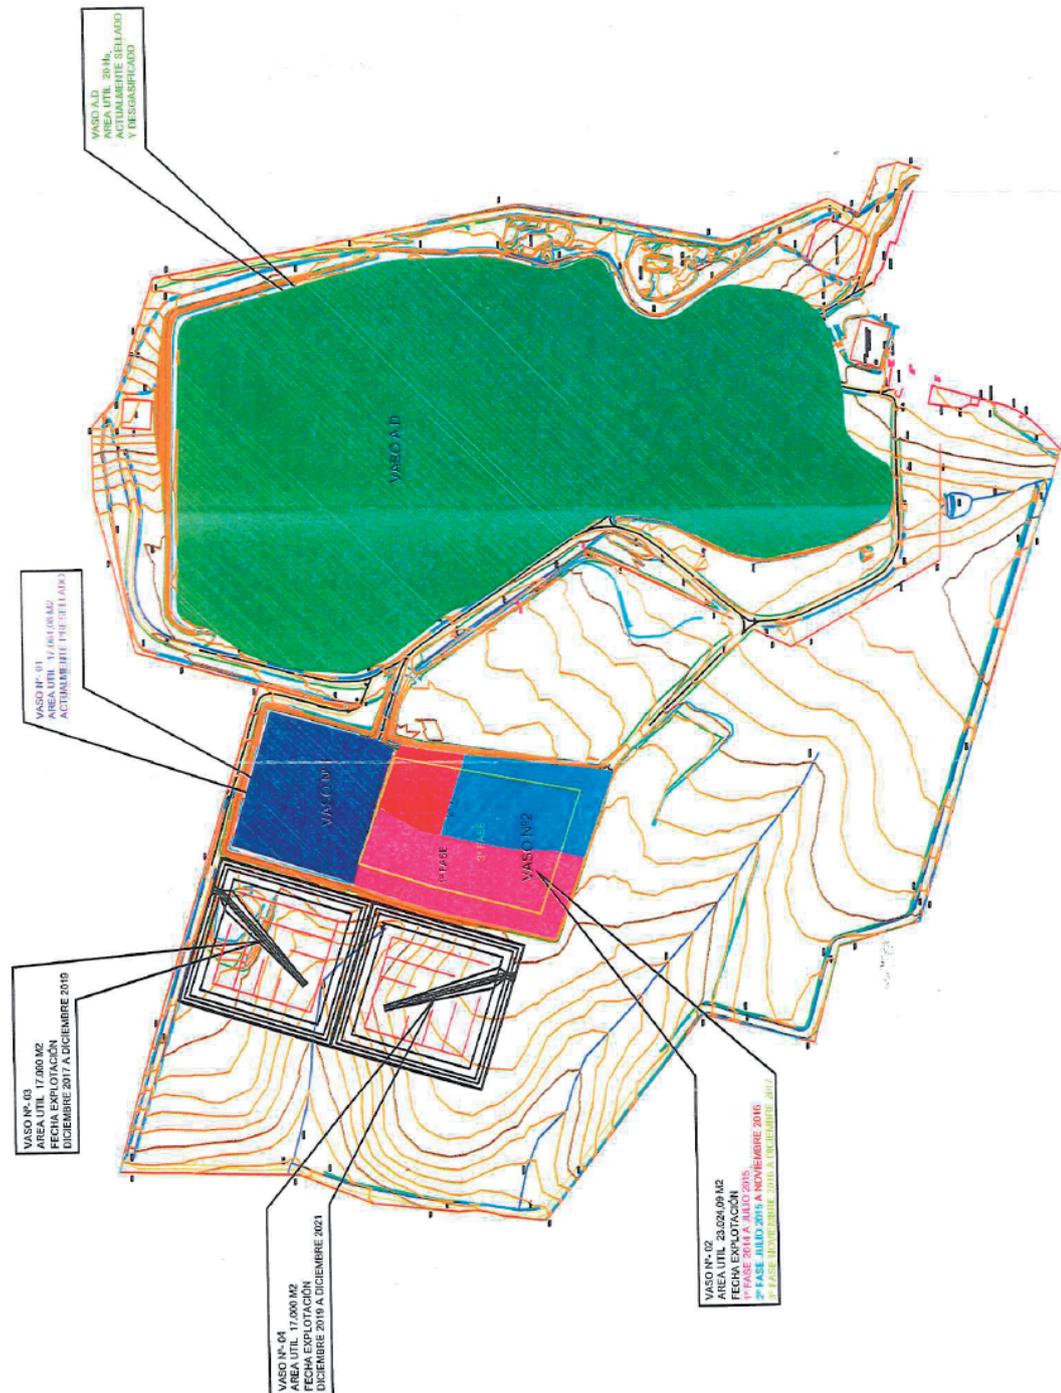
Plano 1 en planta de la instalación. Zona de vasos de vertido.
